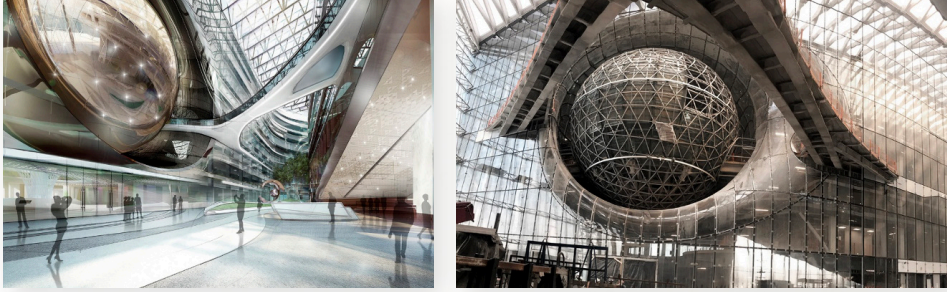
Lakhta Center Tower cephe detayları' [13]
